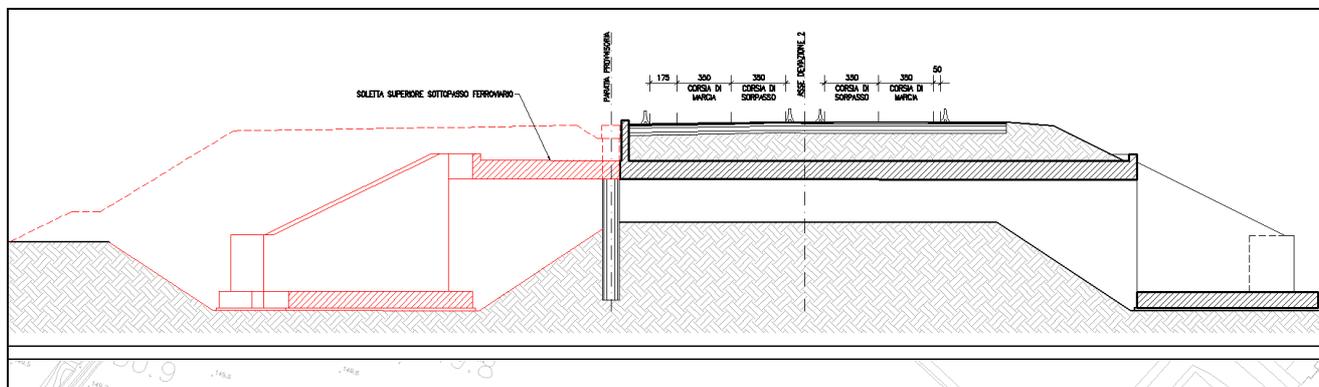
Sezione longitudinale dell'opera in progetto. Fase 4
